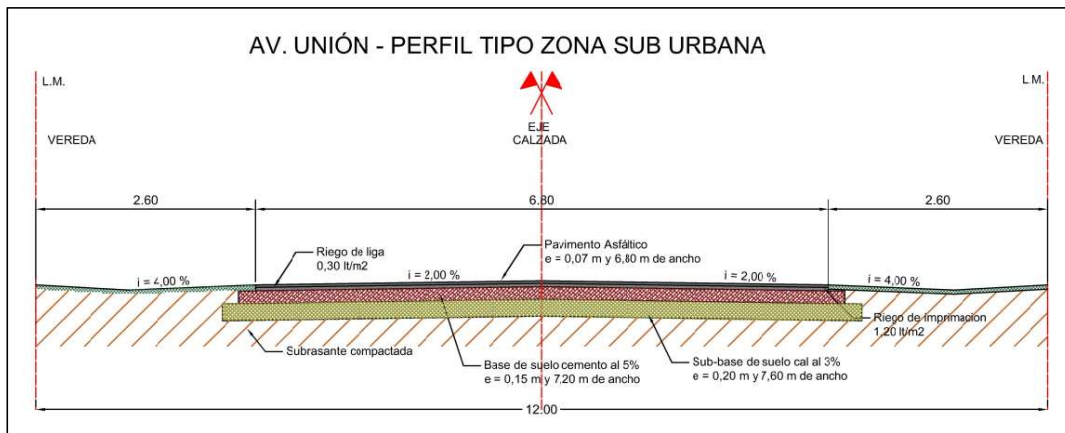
Sección transversal tipo de la Av. Unión en zona sub-urbana
